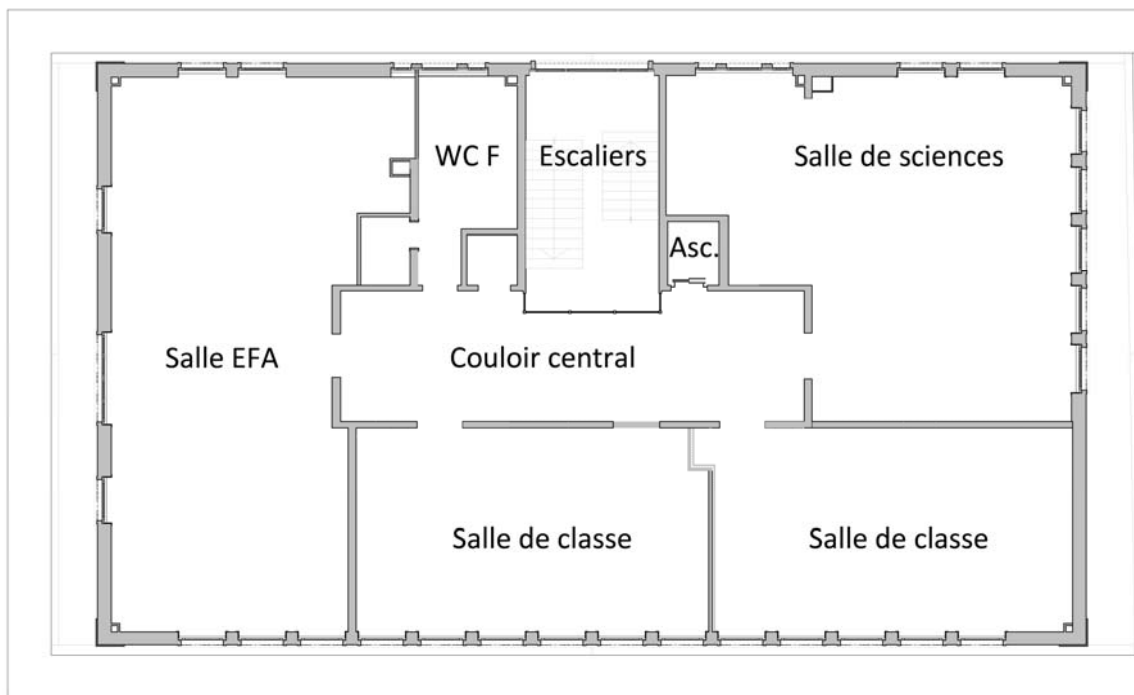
Bâtiment passage Maximilien-de-Meuron, plan du projet du 3^{ème} étage.
